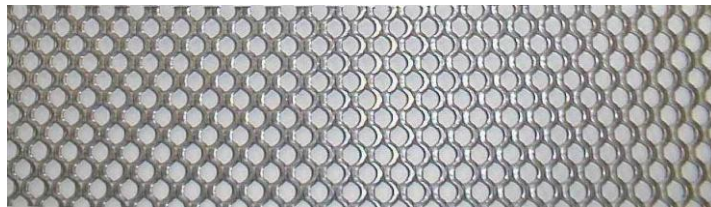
Spezielles Streckmetall zur Verwendung in Holz-Beton-Verbundbauteilen
